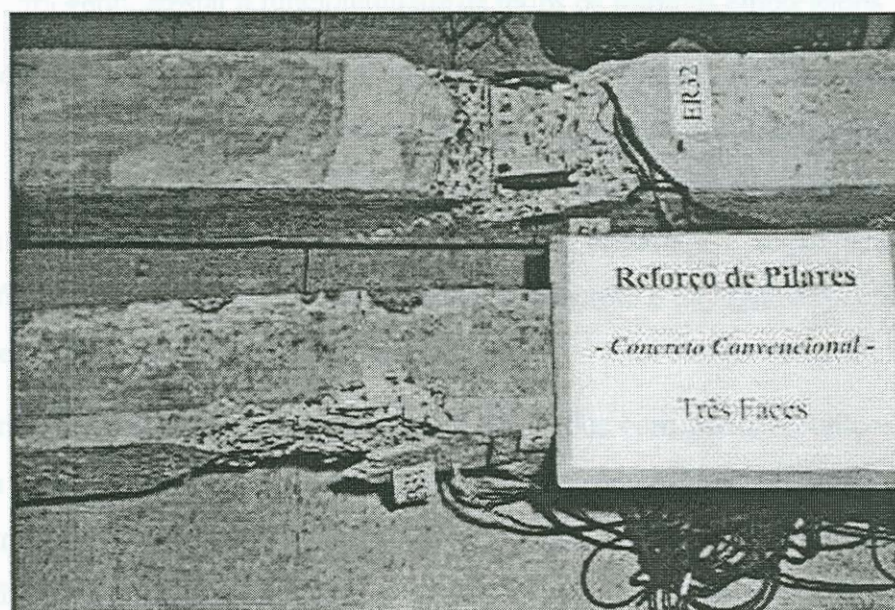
Ruptura dos pilares reforçados com concreto armado em 3 faces.
